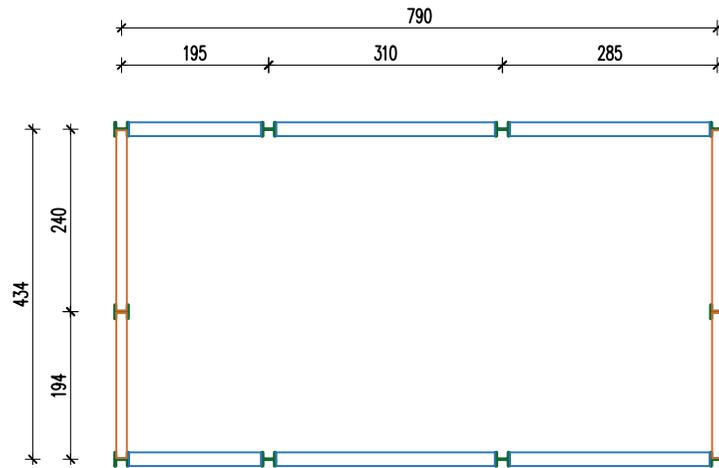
PLATEA DI FONDAZIONE, PIANTA TRAVI, COPERTURA, PARTI FABBRICATO I
